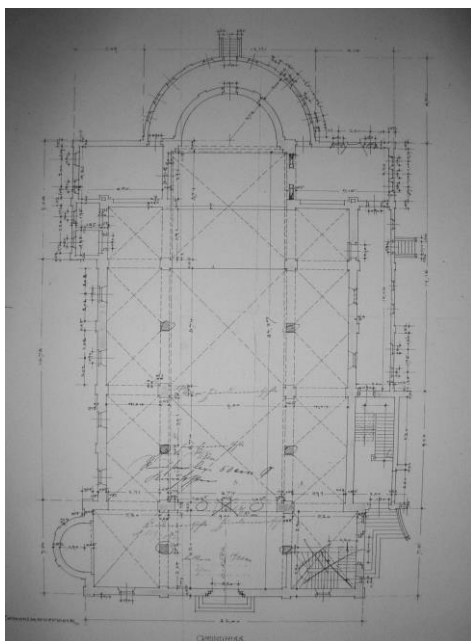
Grundriss, 08.07.1909
